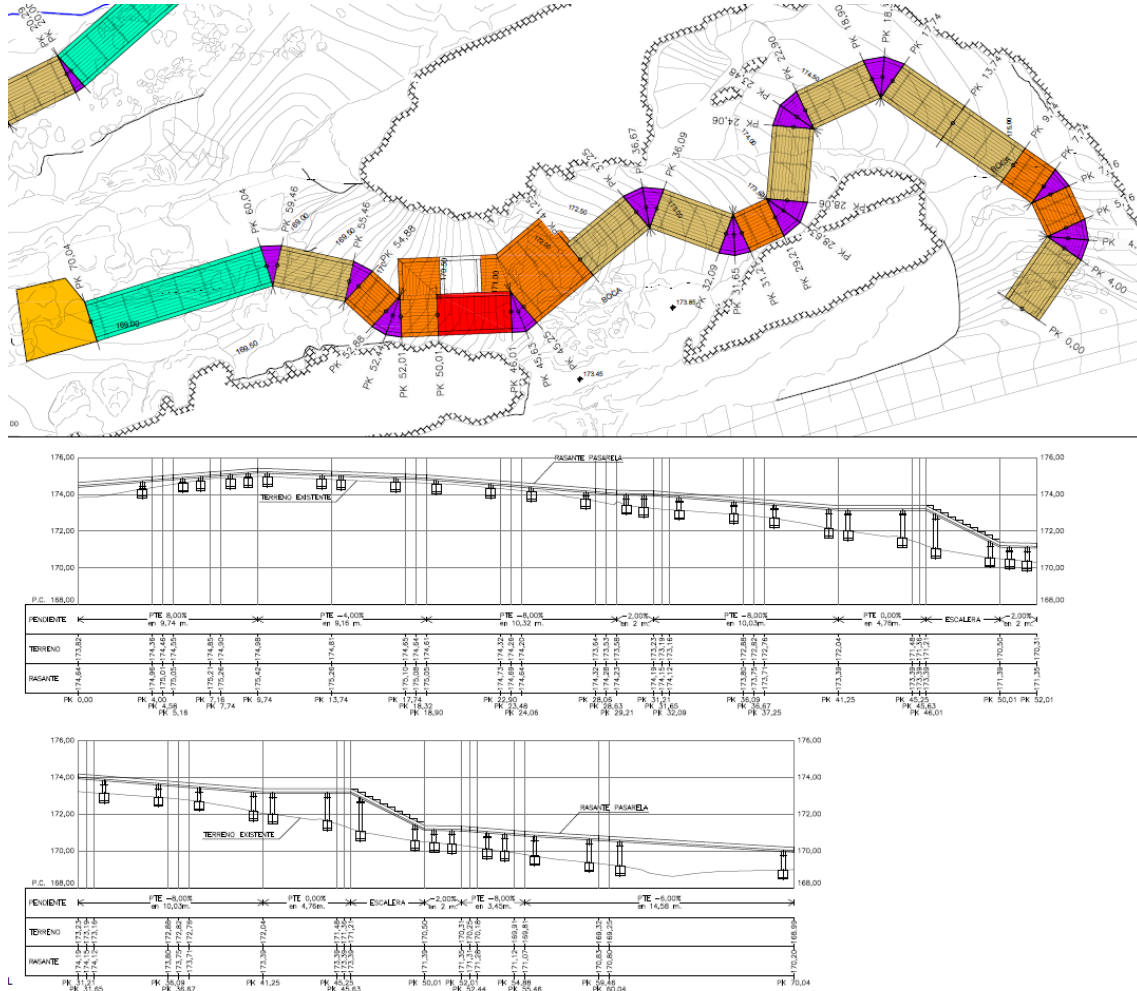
Ventana del plano de planta y alzado del camino de pasarelas DOS
